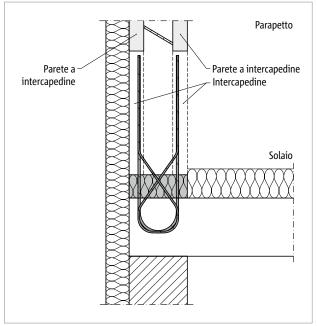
Schöck Isokorb® T tipo AP disposizione verticale: raccordo di una parete a intercapedine
